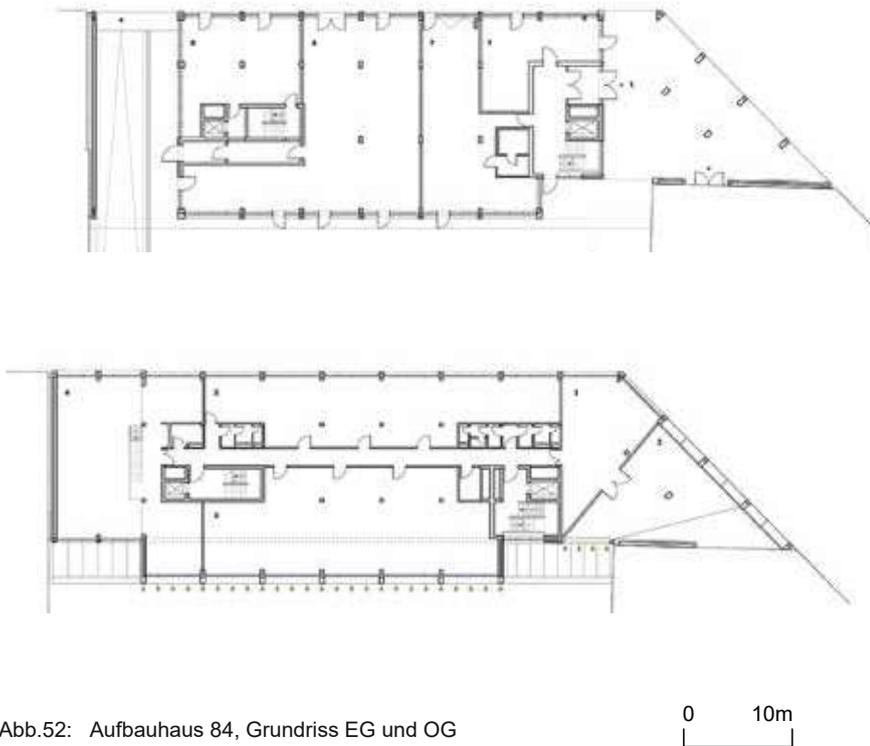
Aufbauhaus 84, Grundriss EG und OG
